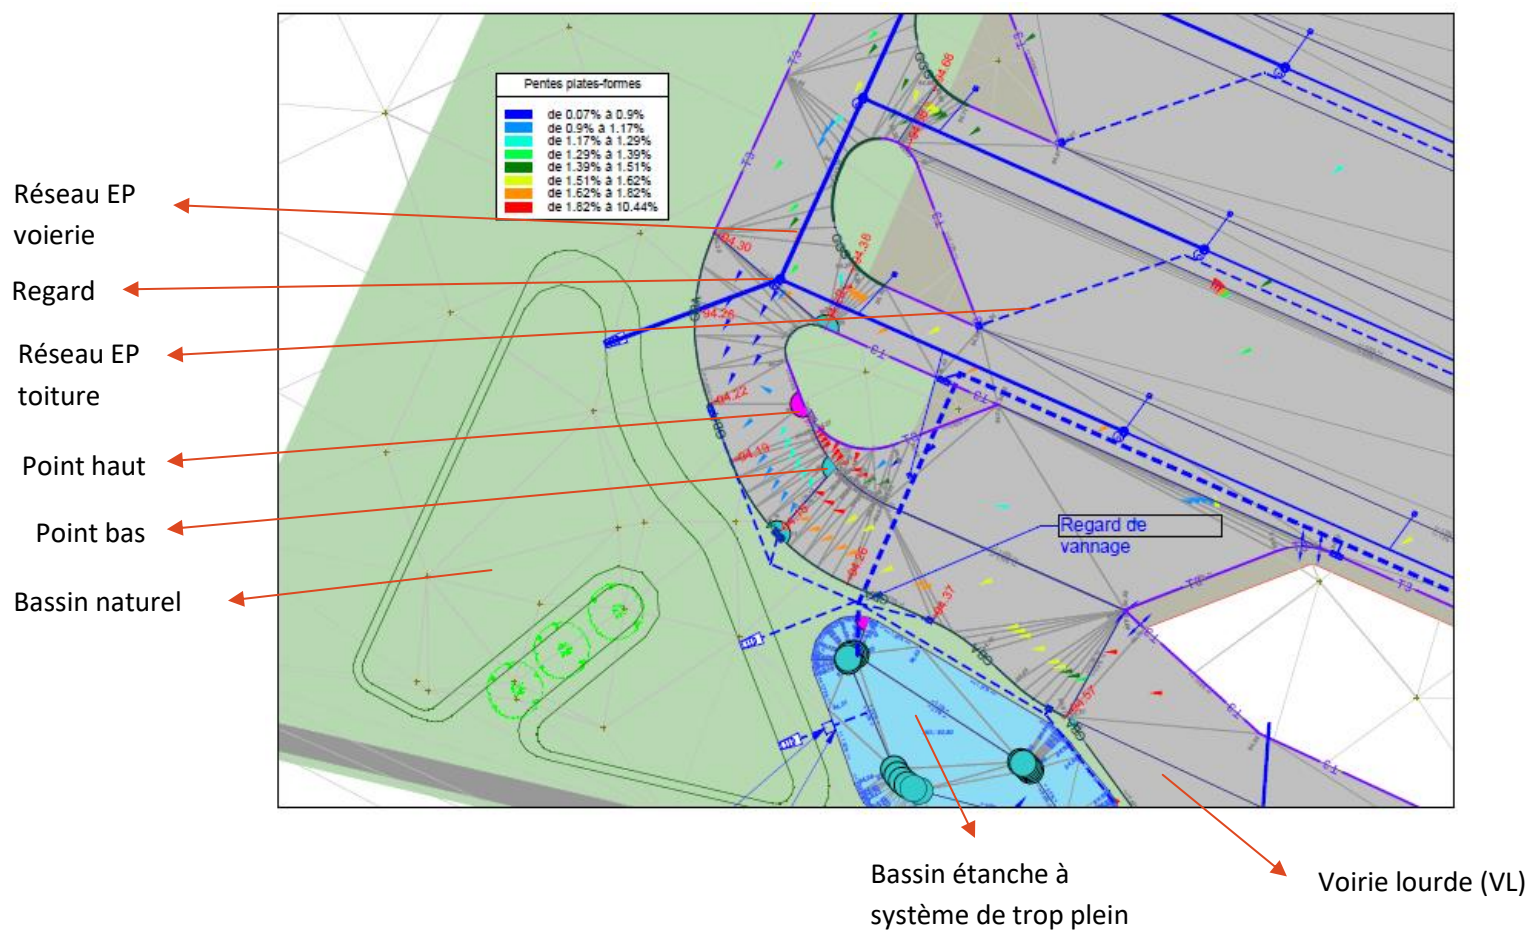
extrait d'un plan de géomètre, source : document de Colas Tours
